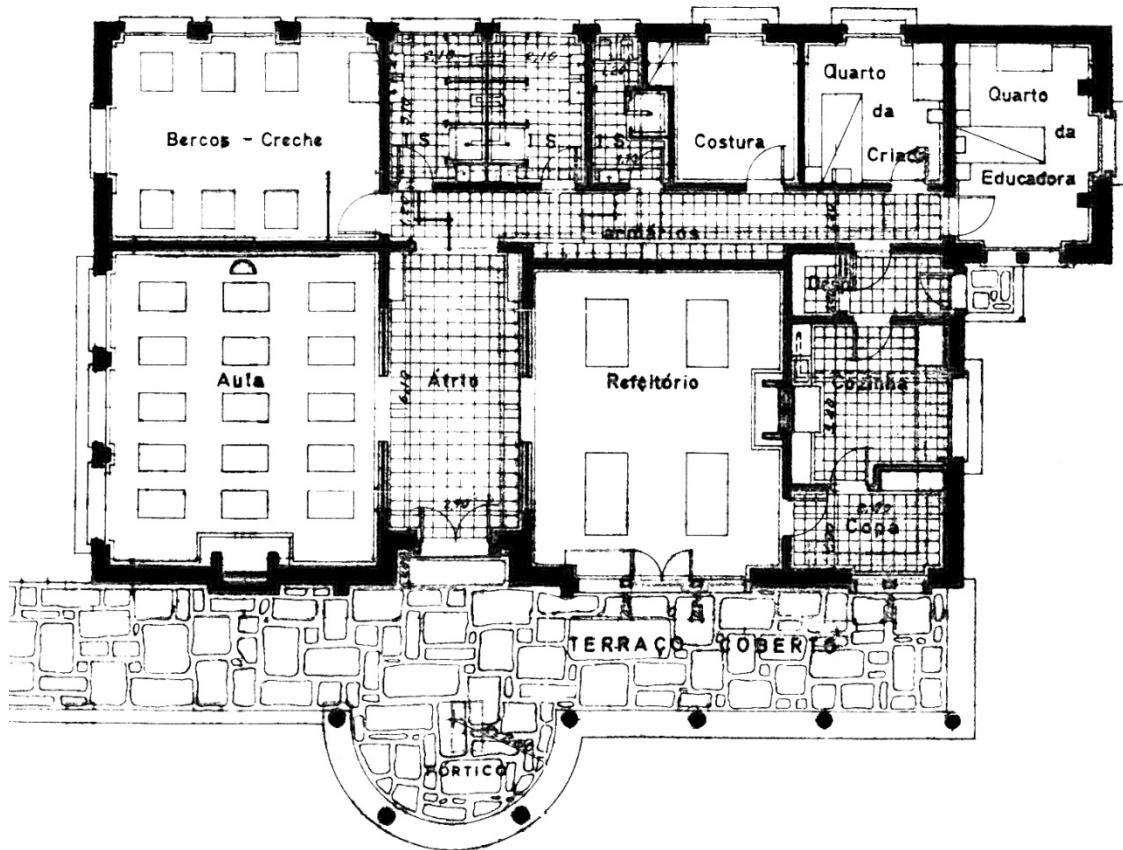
Planta do projecto da Casa da Criança de Travanca de Lagos.
